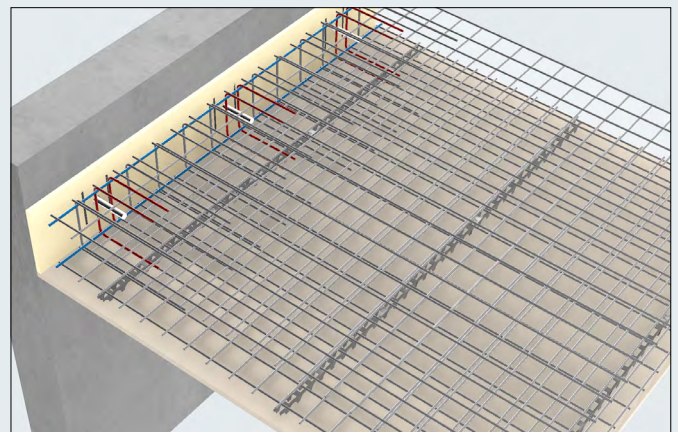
Fugendämmung, Zulagebewehrung je Dorn sowie restliche Bewehrung in der Platte verlegen.
